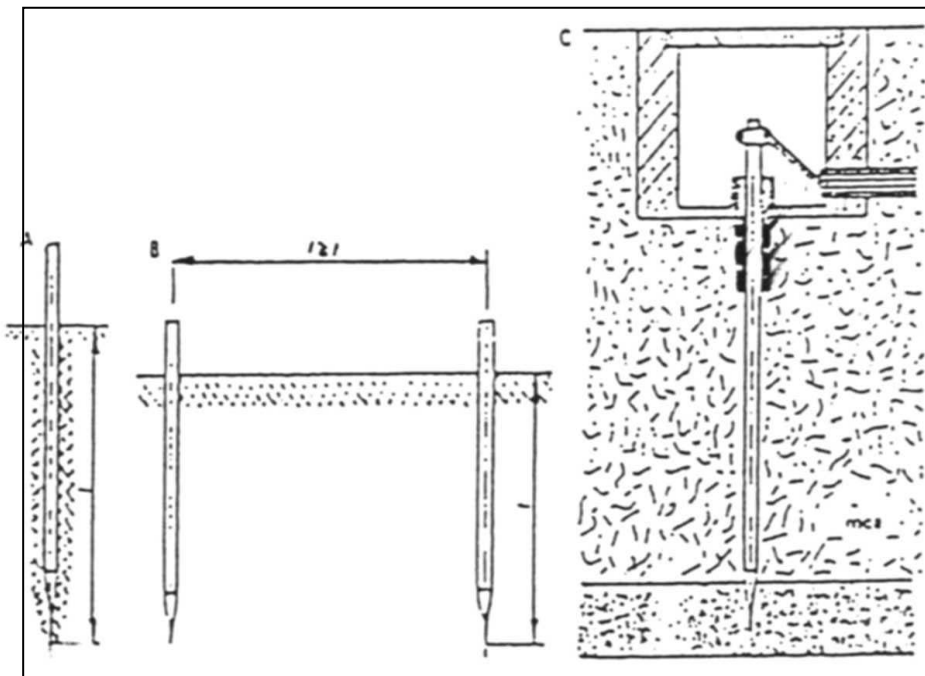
Instalación de las picas de tierra: A, instalación de una pica; B, instalación de dos picas en paralelo; C, instalación de una pica en orqueta de hormigón.
